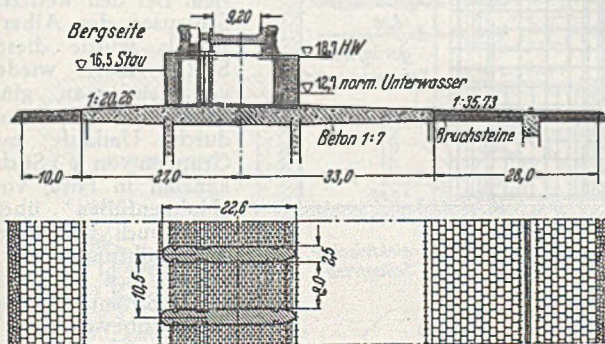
Querschnitt und Teilgrundriß der Stauwehre.
